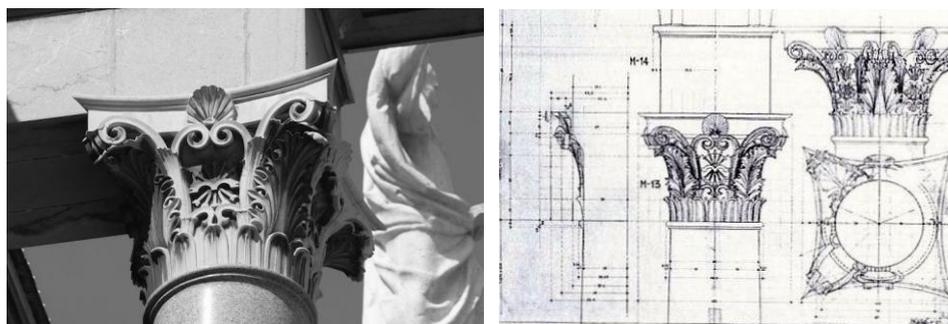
a|b. Detalle de los capiteles de las columnas en los que se puede ver el yugo y las flechas tanto en la fotografía como en los planos originales donde se detalla su alzado y sección.
